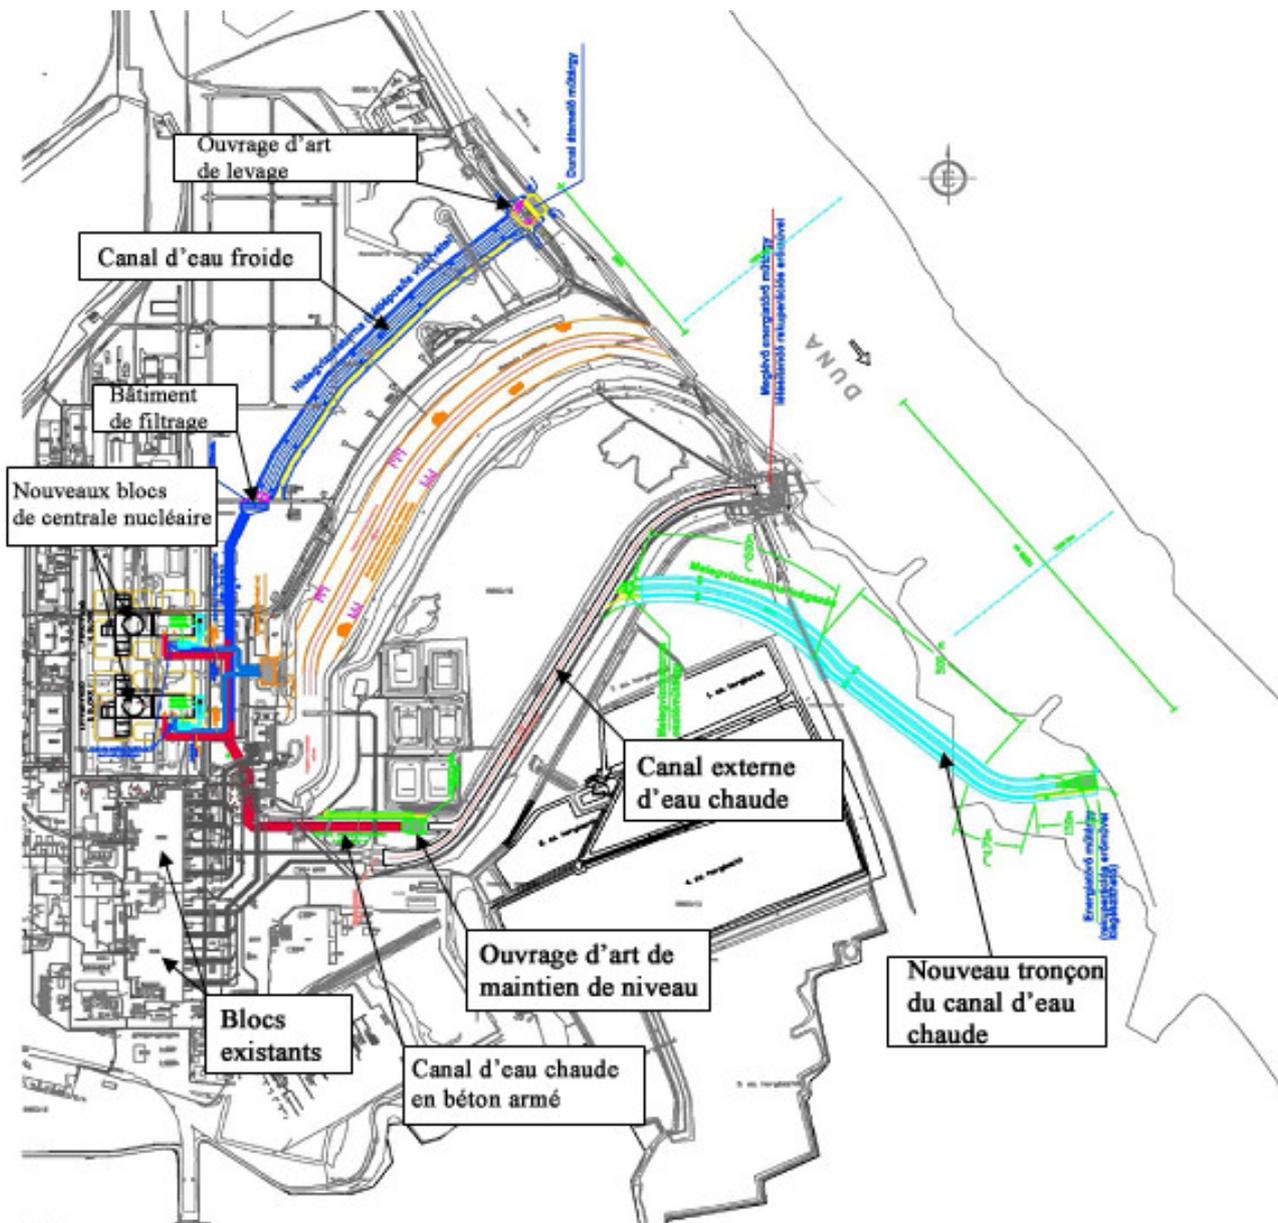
Les différentes parties et le plan de situation du système de refroidissement à l'eau fraîche en deux étapes
